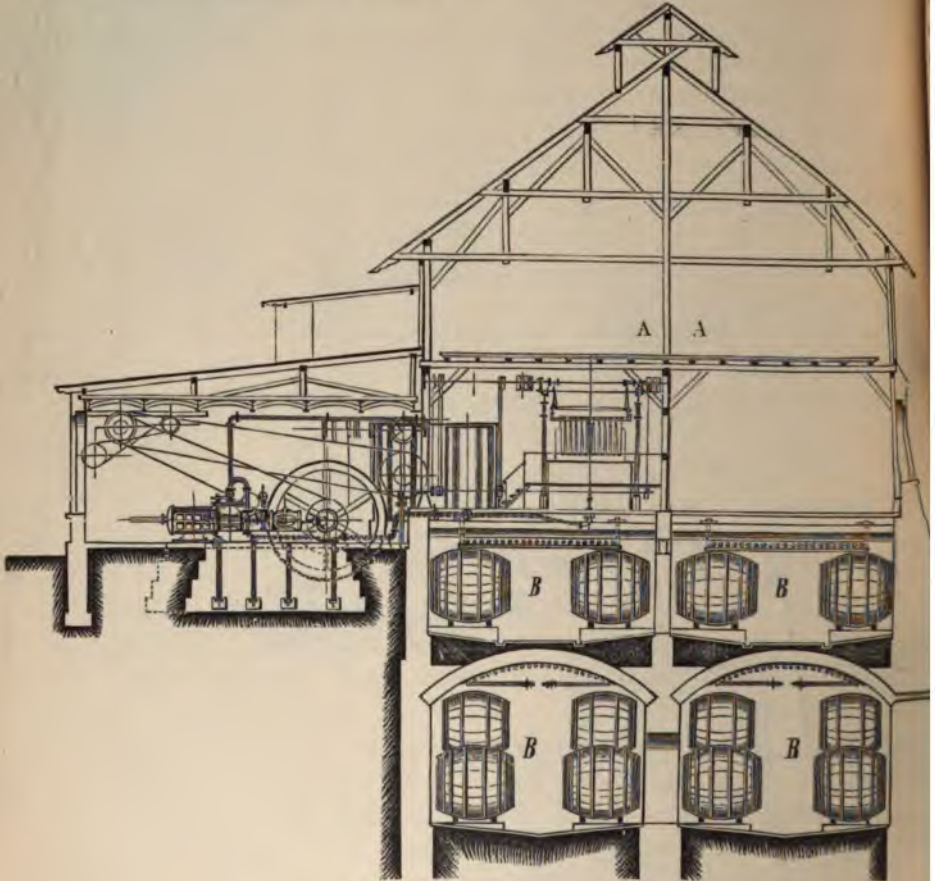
Aufriss, Schnitt A—B des Grundrisses.
